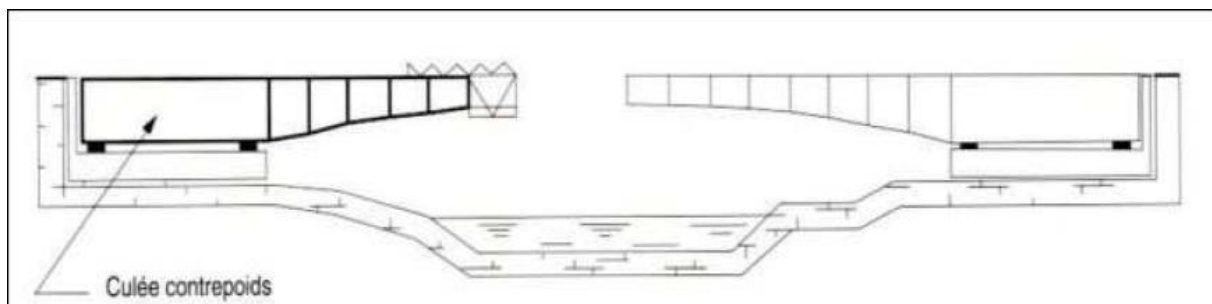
Construction par encorbellement successifs à partir d'une travée contrepoids.
